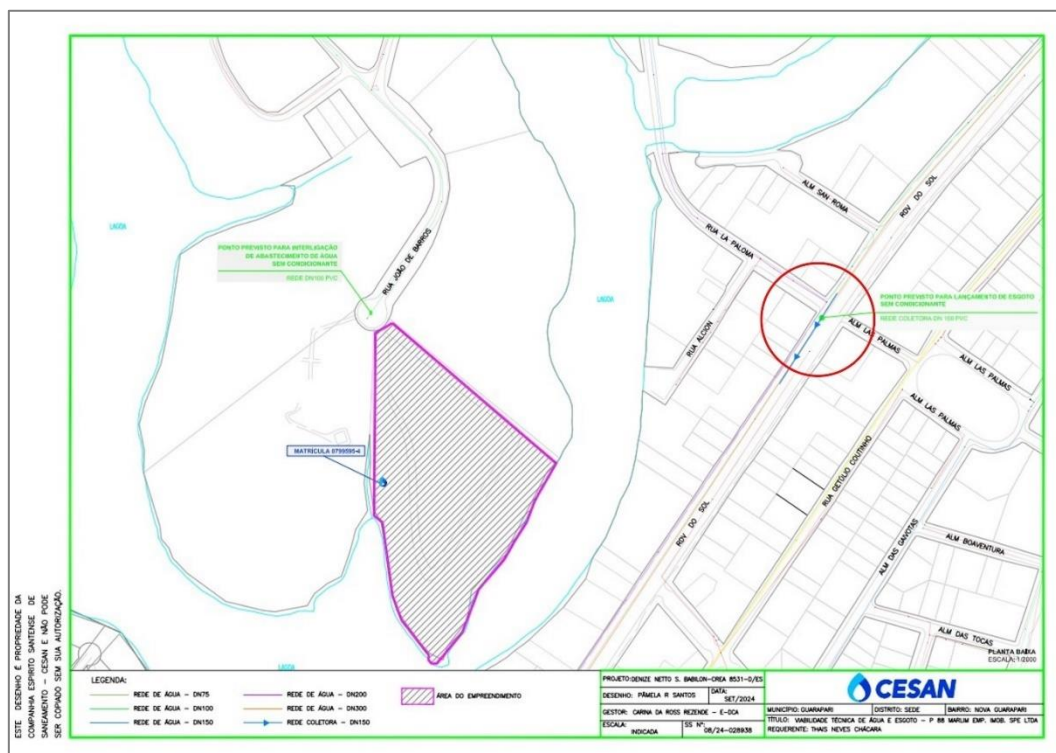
Croqui da CESAN com localização do ponto de ligação do incremento do empreendimento com a rede existente. Fonte: arquivo CROQUI PVT-216-2024.pdf
